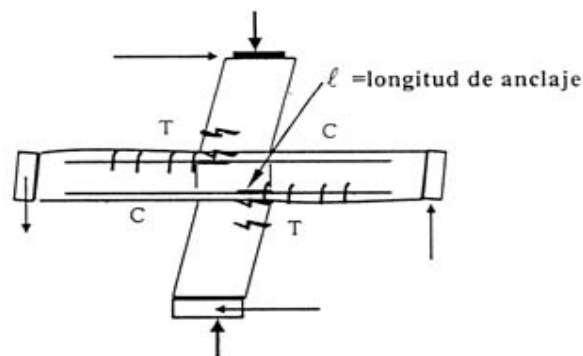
Junta interior viga plana-columna sujeta a carga lateral.
